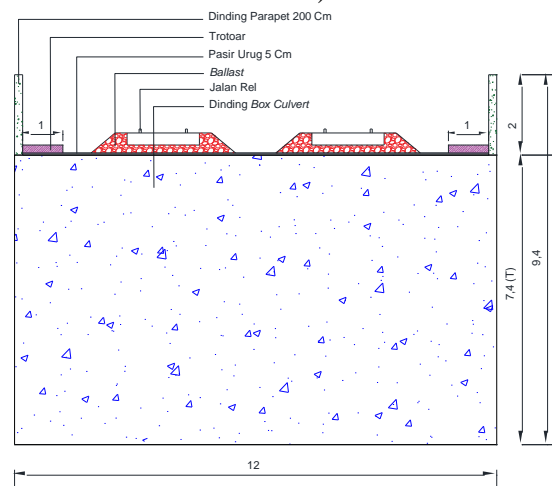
Tampak Depan Dari Arah Subang Perencanaan *Underpass
